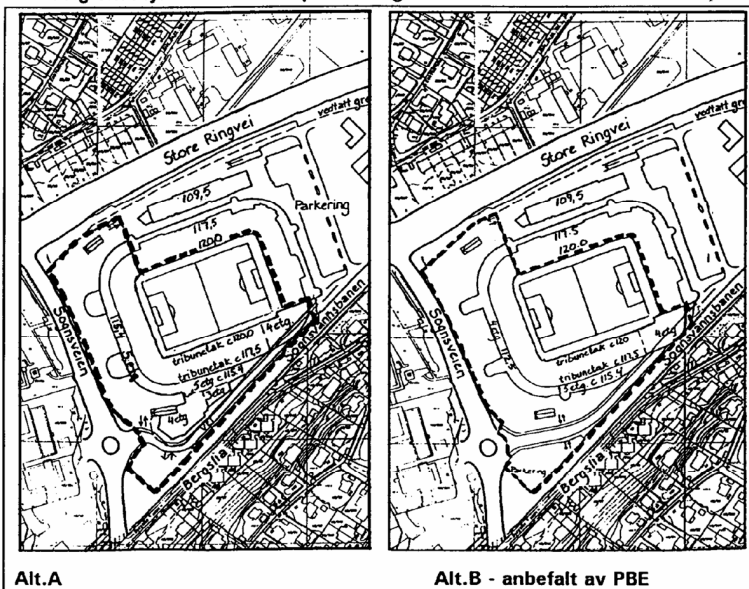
Reguleringsplan II: Ullevaal Stadion
